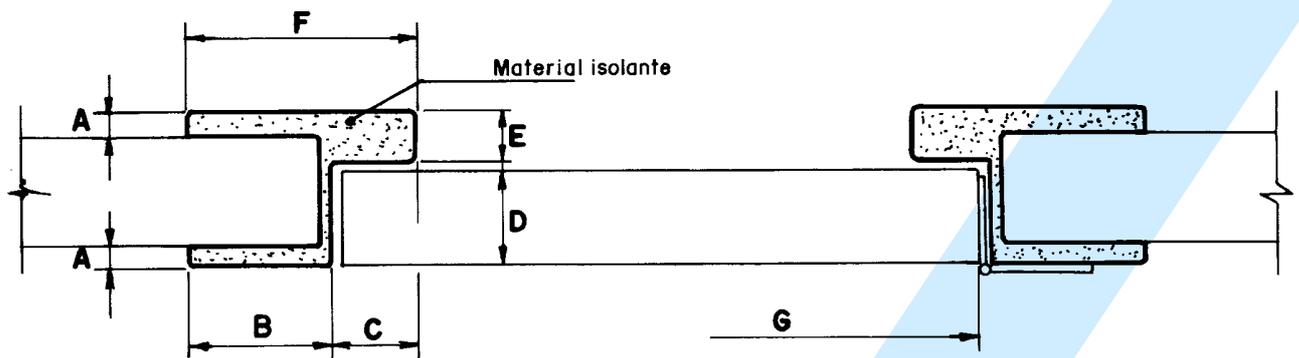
Batente tipo I - Para paredes de alvenaria e concreto
